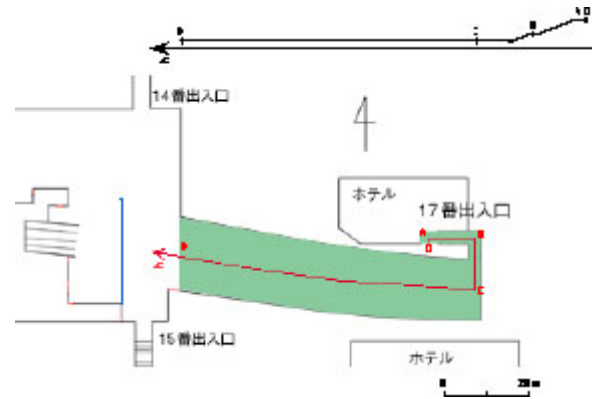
地下鉄博多駅筑紫口側改札口付近の平面図
